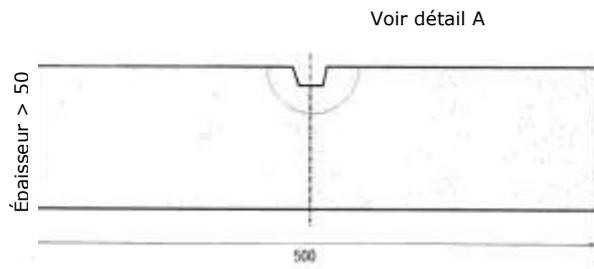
Sto-Panneaux pour Bossage Type I (dimensions en mm)
